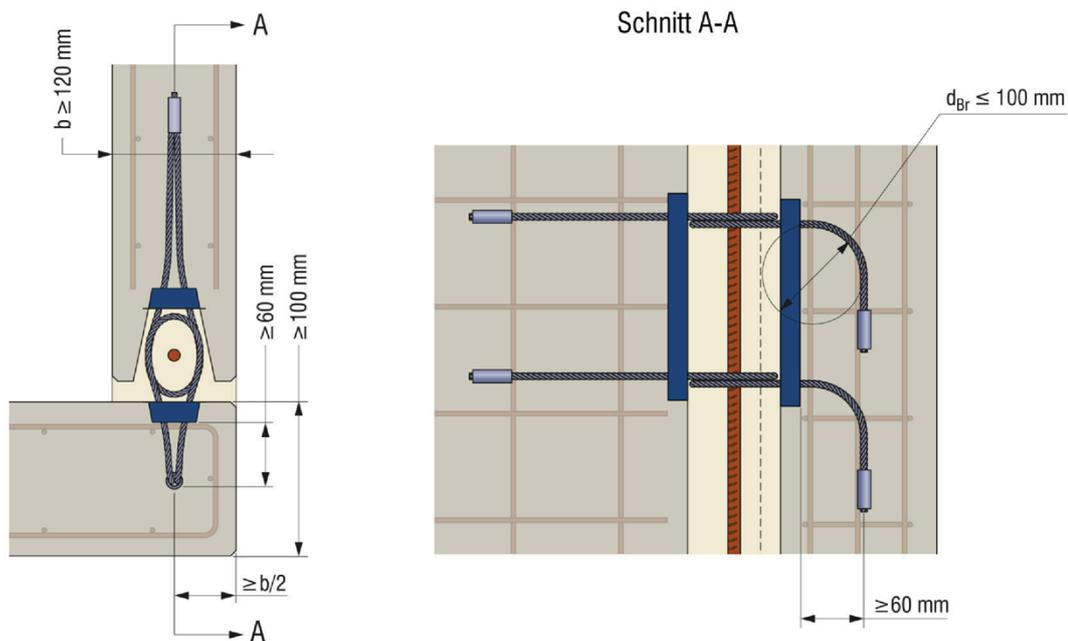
Wand – Wand – ECKVERBINDUNG - Detail mit reduzierter Zulagebewehrung
